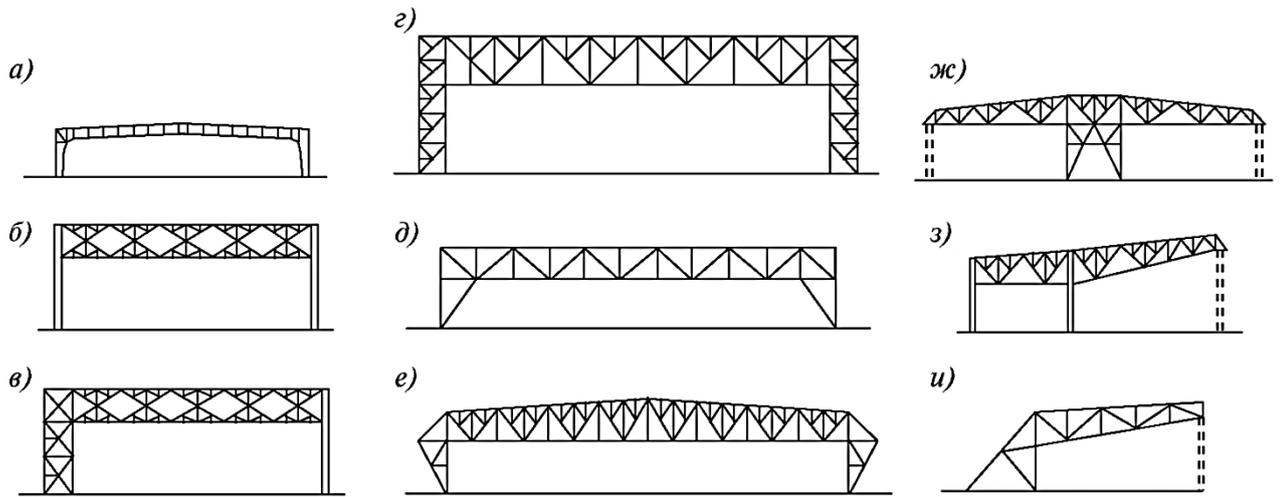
Рамы: а - сплошная; б - сквозная с гибкими стойками; в - с одной гибкой стойкой; г - с жесткими стойками; д - двухшарнирная; е - с подкосами снаружи; ж - двухконсольная; з - одноконсольная; и – консольная
